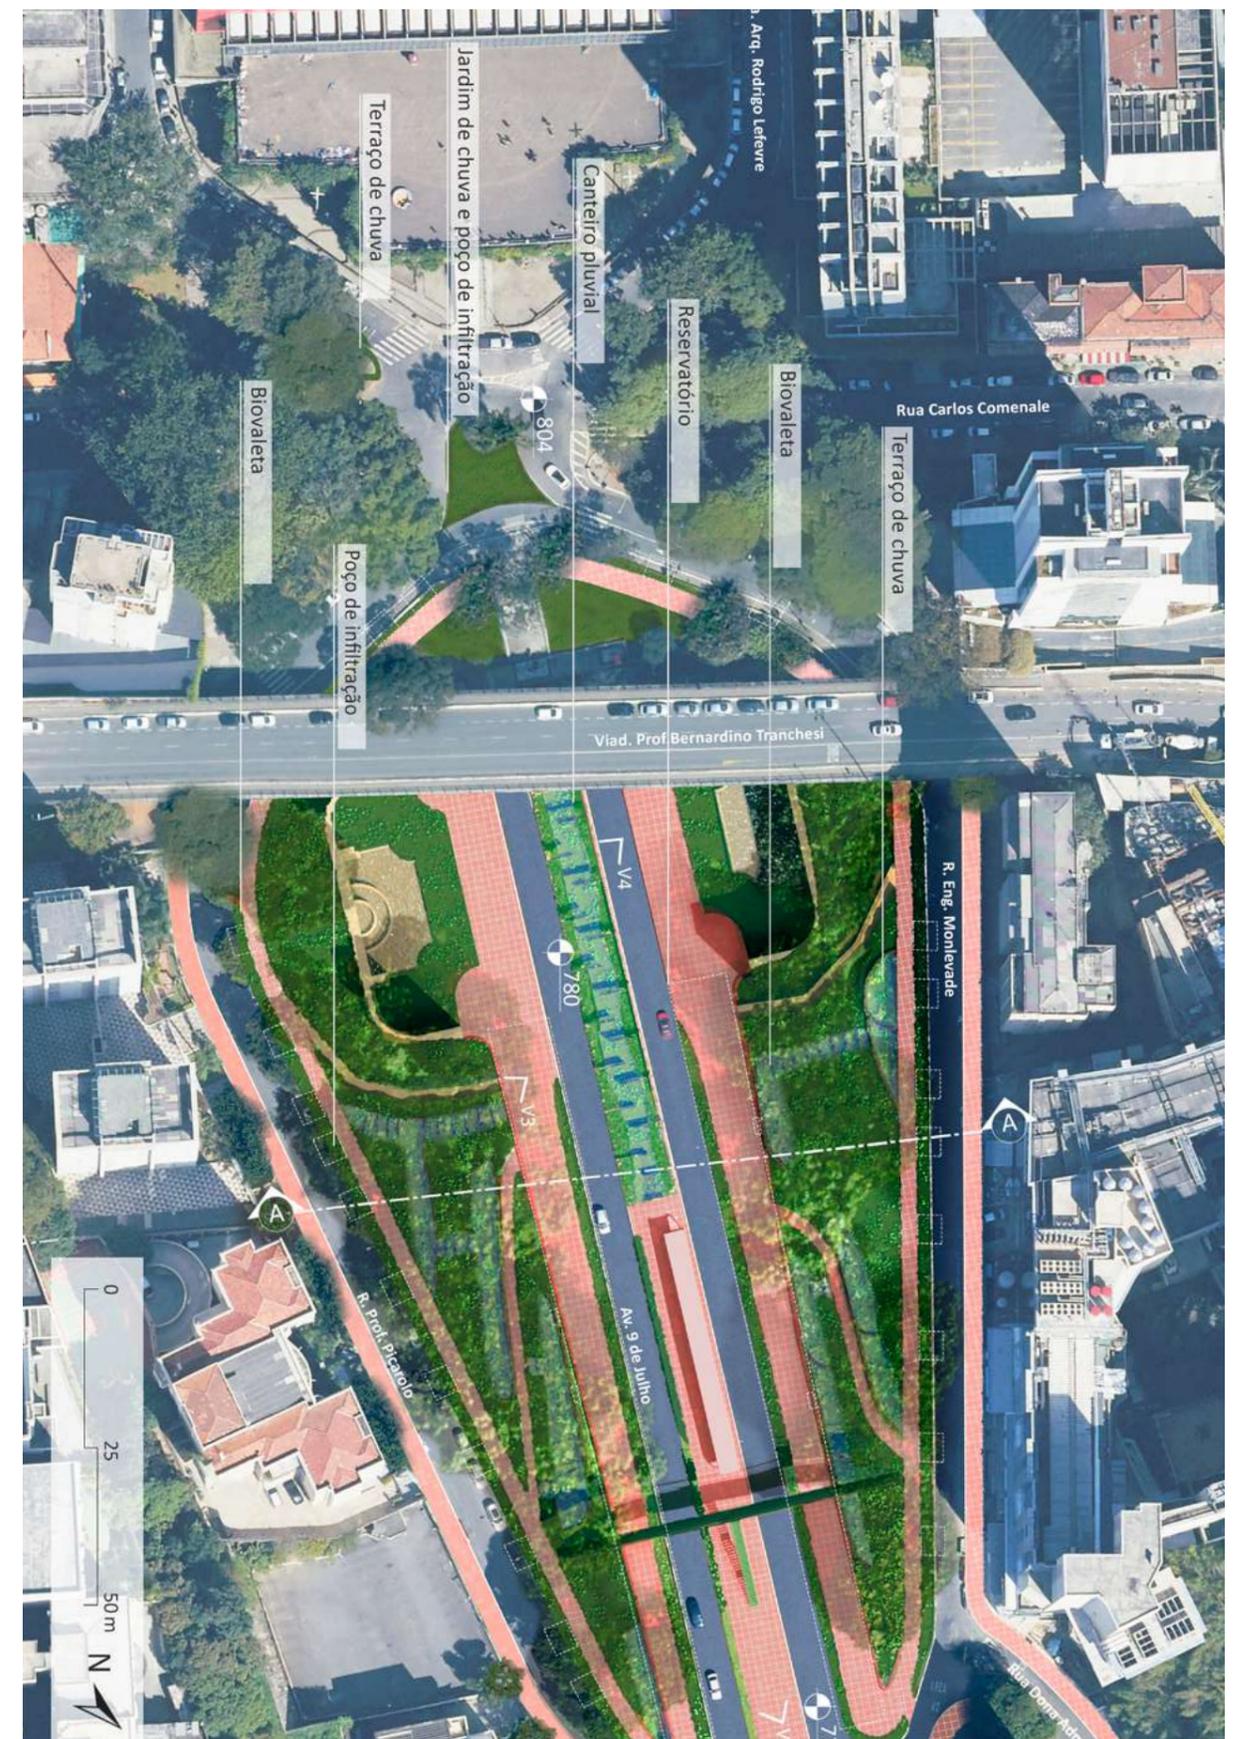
Planta da Área de infiltração Saracura localizando os dispositivos de infraestrutura verde: biovaletas, terraços de chuva, poços de infiltração, canteiro pluvial e reservatório subterrâneo (Fonte: Prefeitura de São Paulo, FCTH, 2021)..
